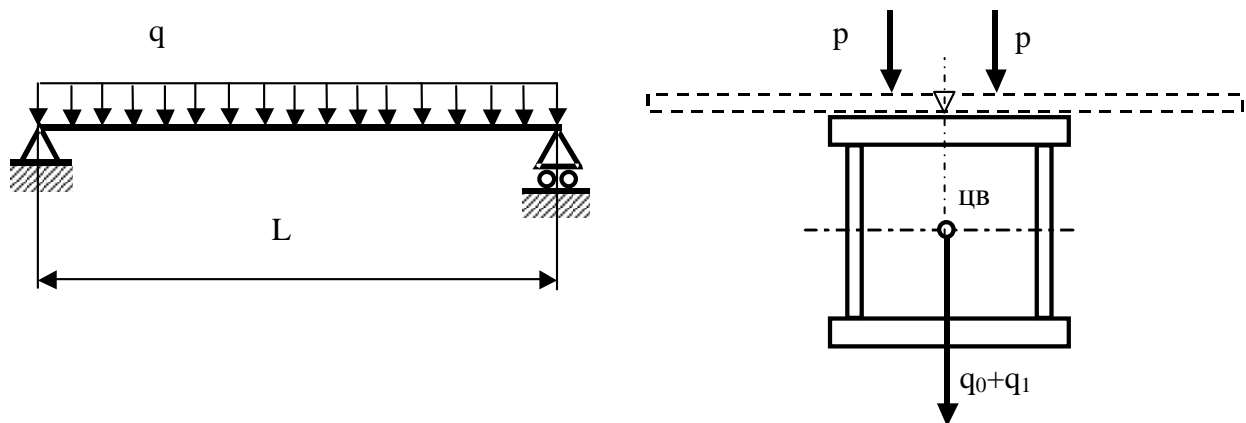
Розрахункова схема нижньої опорної балки стенда.
